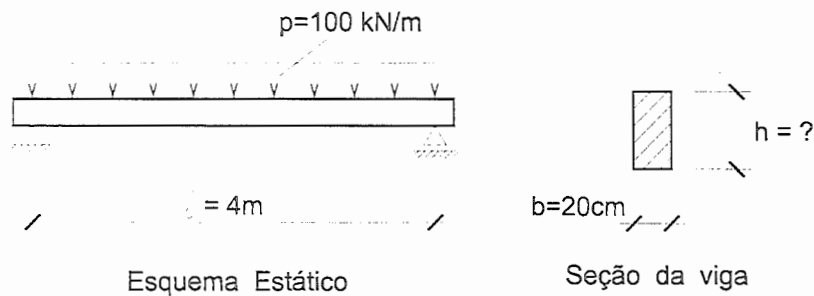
Viga bi-apojada com carregamento distribuído uniformemente
